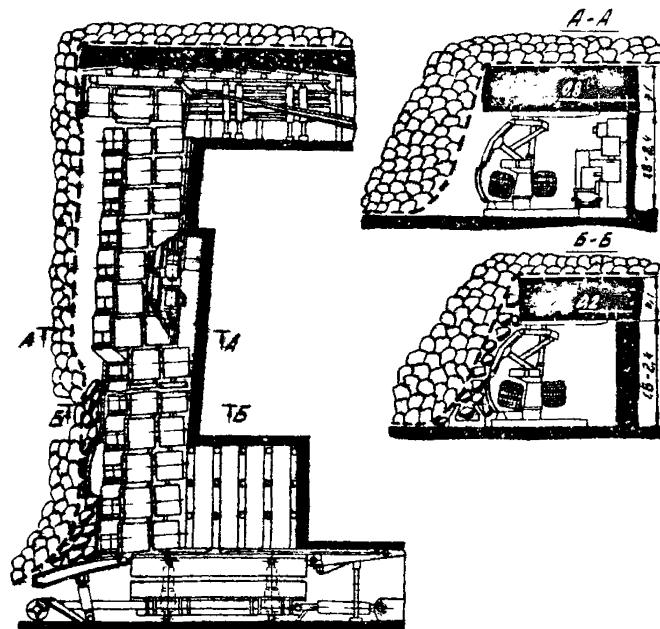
Схема послонной выемки угля под гибким перекрытием с применением комплекса КИК
